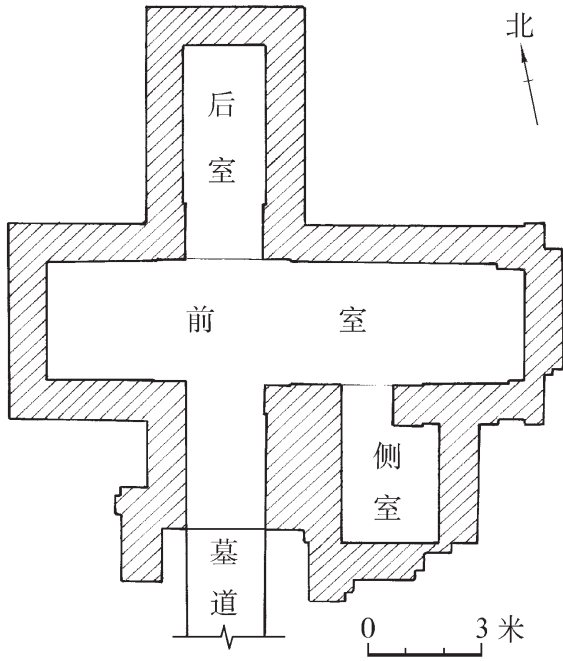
河南省洛阳市白马寺汉墓平面图 (1/200)
